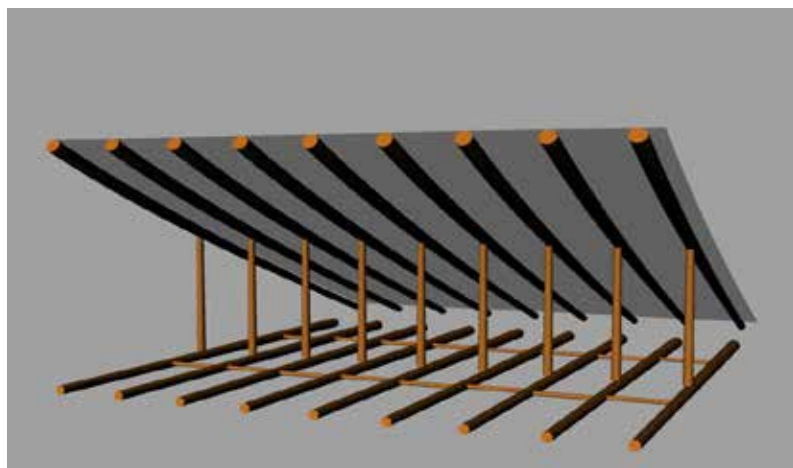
Columnas Con Pilar Redondo. Fuente: Plataforma Arquitectura (2021)
